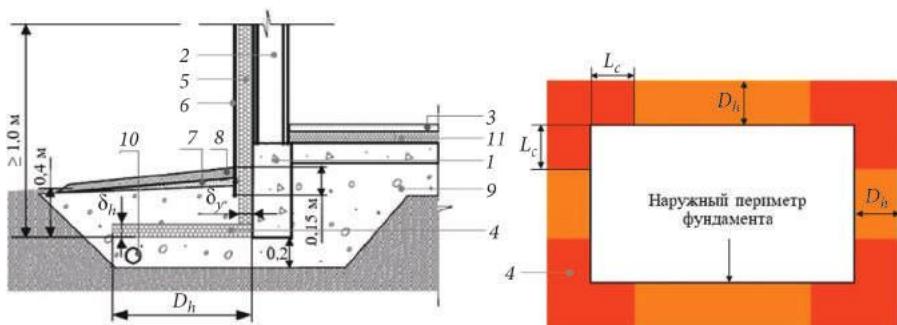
Схема укладки теплоизоляции в фундаментах отапливаемых зданий: 1 — фундамент; 2 — стена здания; 3 — пол здания; 4 — горизонтальная теплоизоляция (XPS плиты); 5 — вертикальная теплоизоляция (XPS плиты); 6 — защитное покрытие; 7 — песчаная подготовка под отмостку; 8 — асфальтовая или бетонная отмостка; 9 — непучинистый грунт; 10 — дренаж; 11 — теплоизоляция пола
